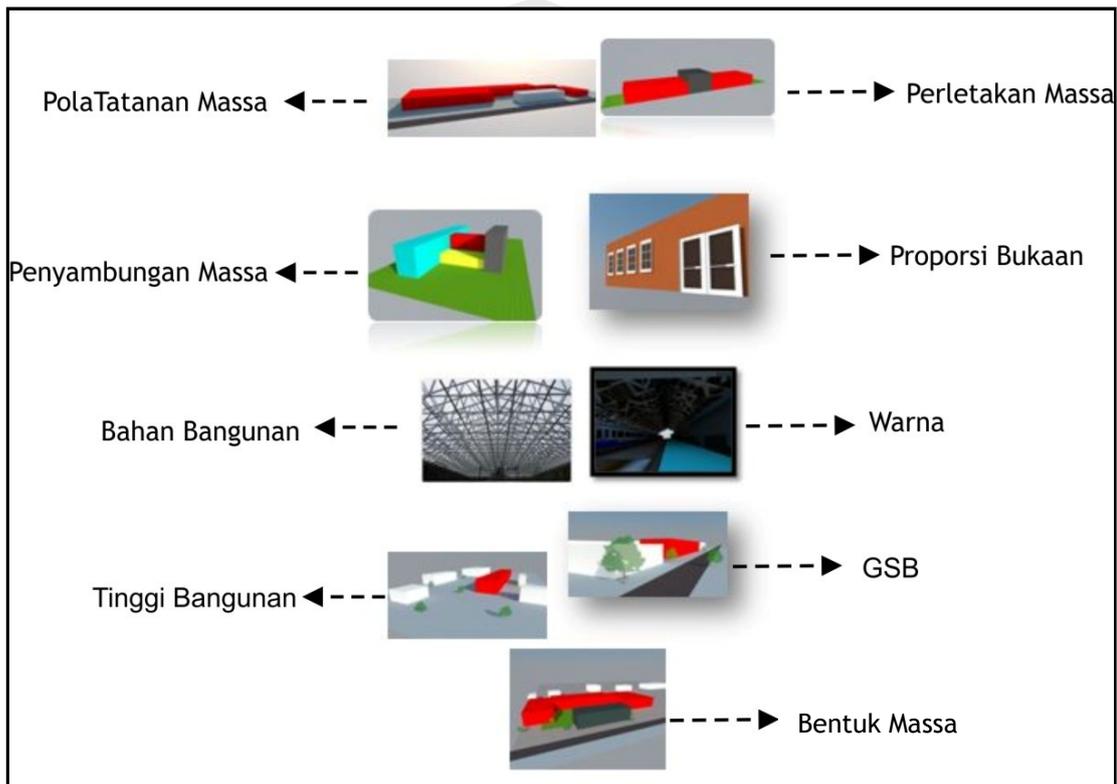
Konsep bangunan lama dan bangunan baru
